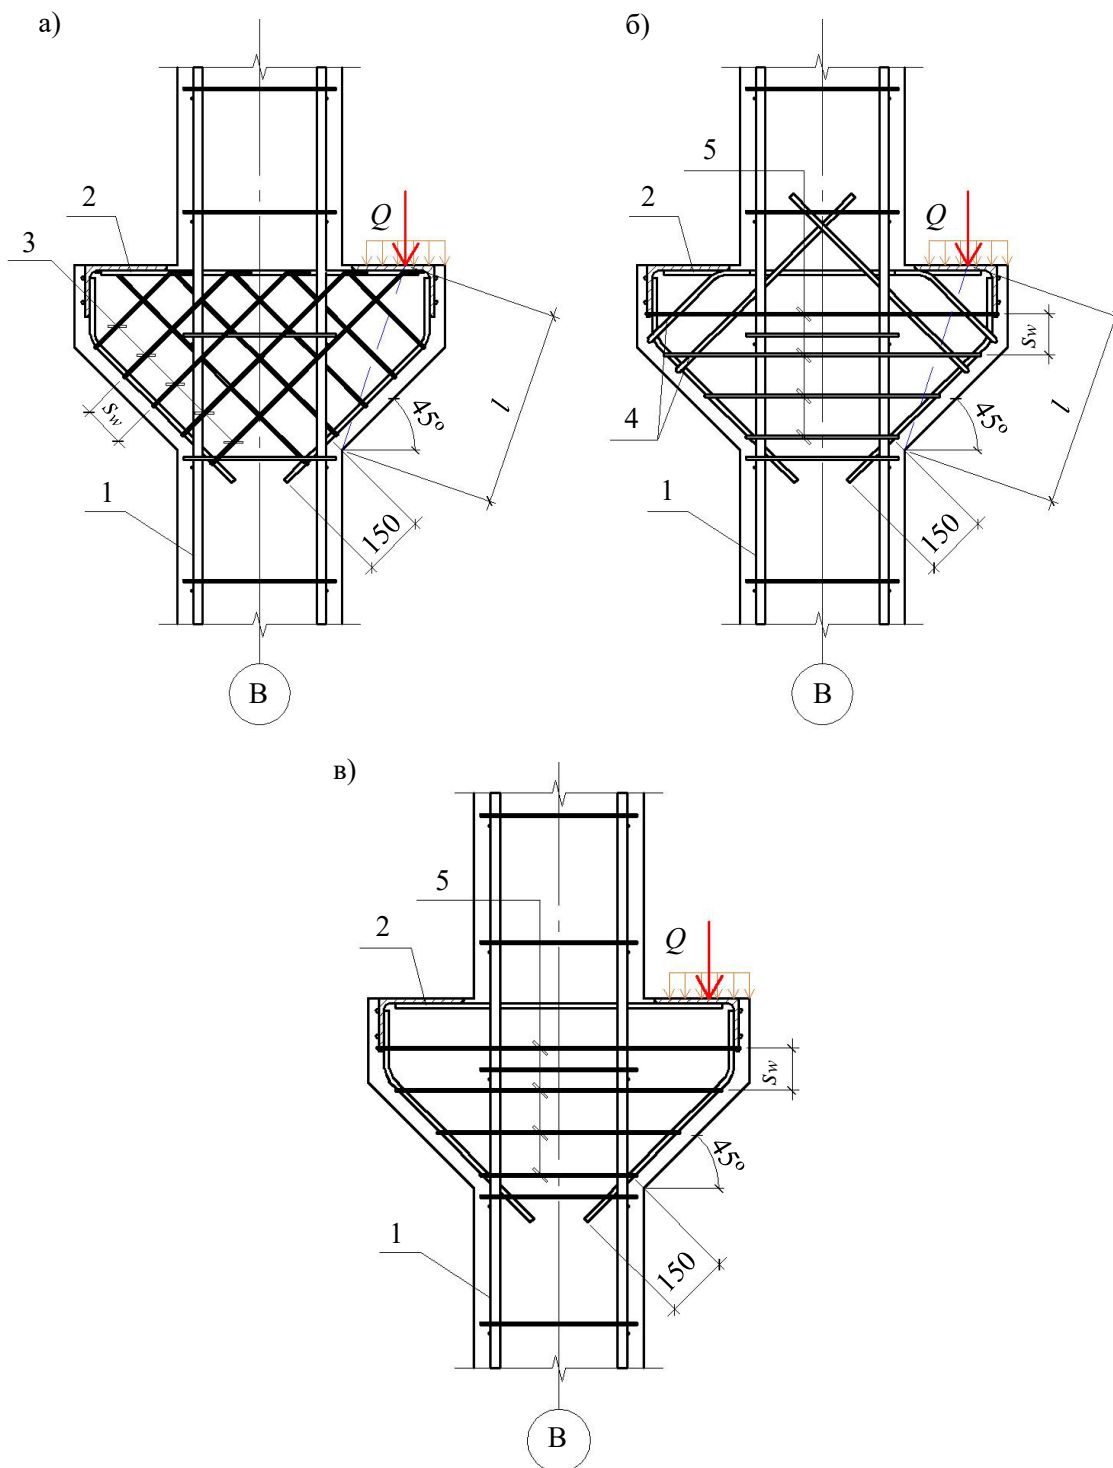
Схема армирования коротких консолей [11]: а) наклонными хомутами; б) отогнутыми стержнями и горизонтальными хомутами; в) горизонтальными хомутами; 1 – каркас колонны; 2 – продольная рабочая арматура консоли; 3 – наклонные хомуты; 4 – отгибы; 5 – горизонтальные хомуты
